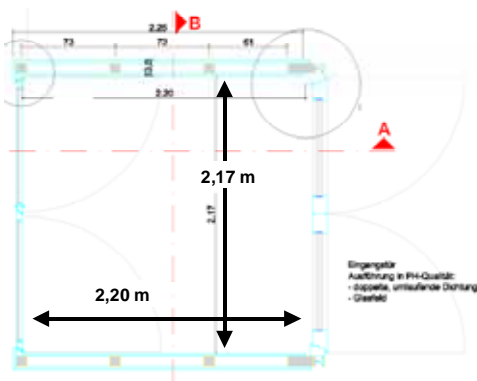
Windfang Haupteingang / Grundriss / Ansicht (nach Architekten 4a, Stuttgart)
